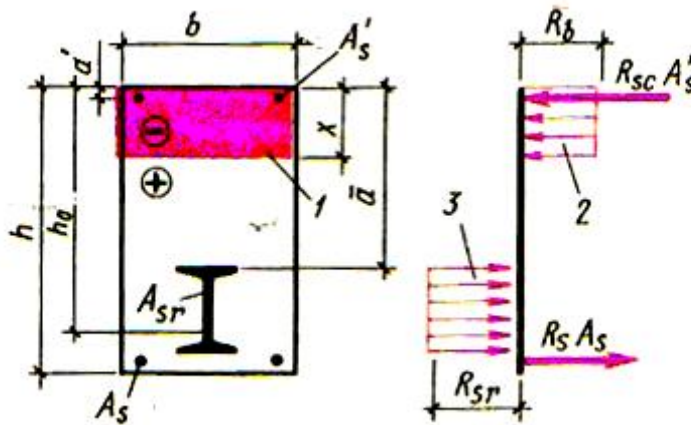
Армуння елемента жорсткою арматурою низьким профілем: 1 – стиснута зона перерізу, 2 – напруження в бетоні стиснутої зони, 3 – напруження розтягу в жорсткій арматурі
